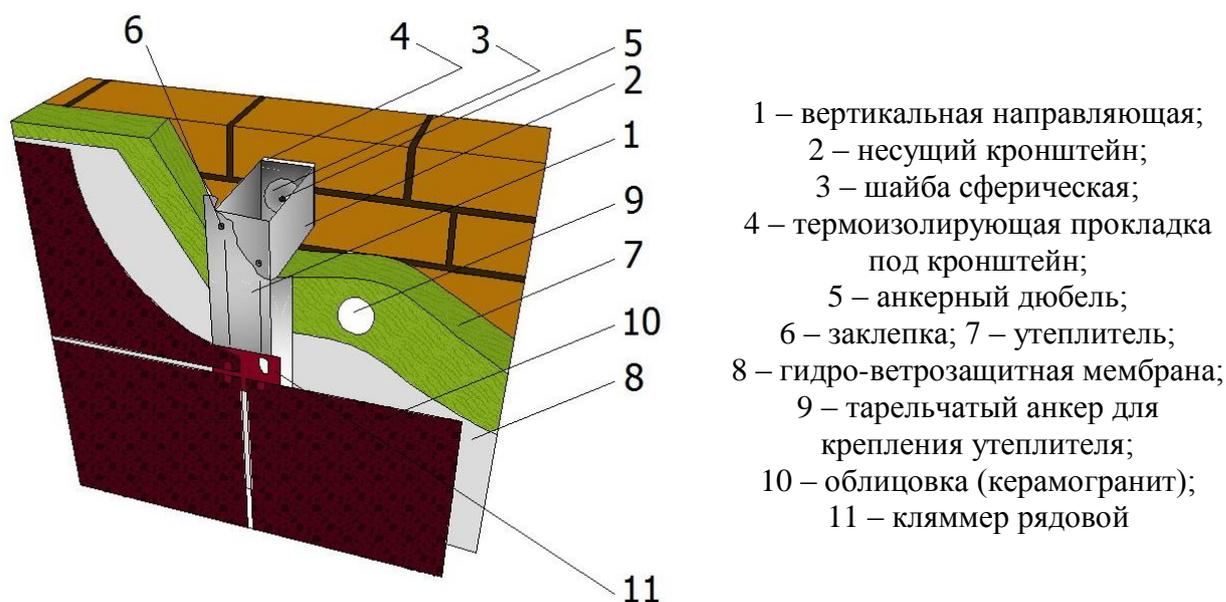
Конструктивное решение вентилируемого фасада «РУСЭКСП»
